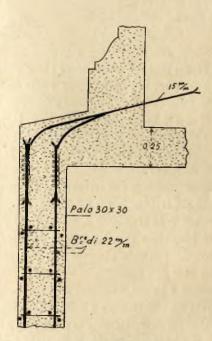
Collegamento delle teste dei pali del cassero al basamento della pila.
